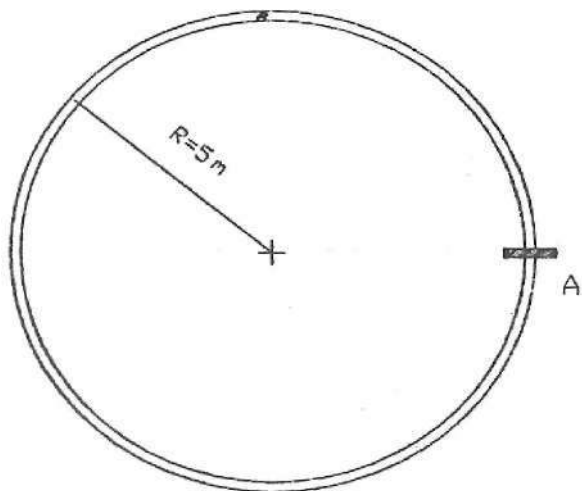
Viga curva fechada engastada no pilar A
